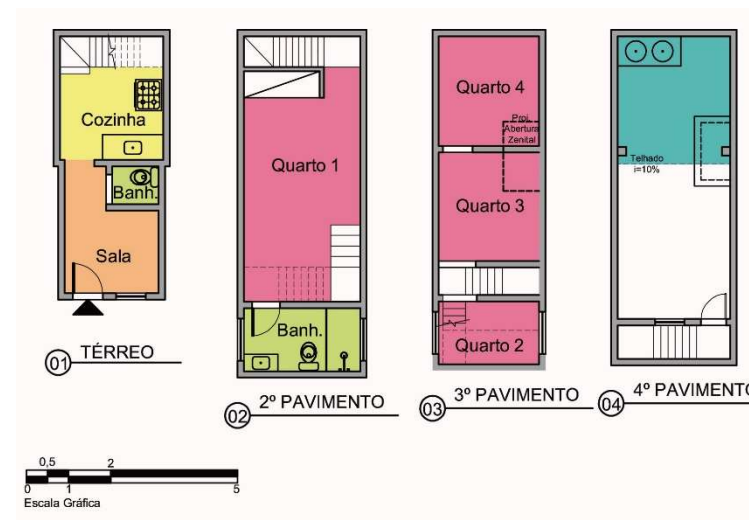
plantas da casa d. Dina. fonte: acervo da autora.
